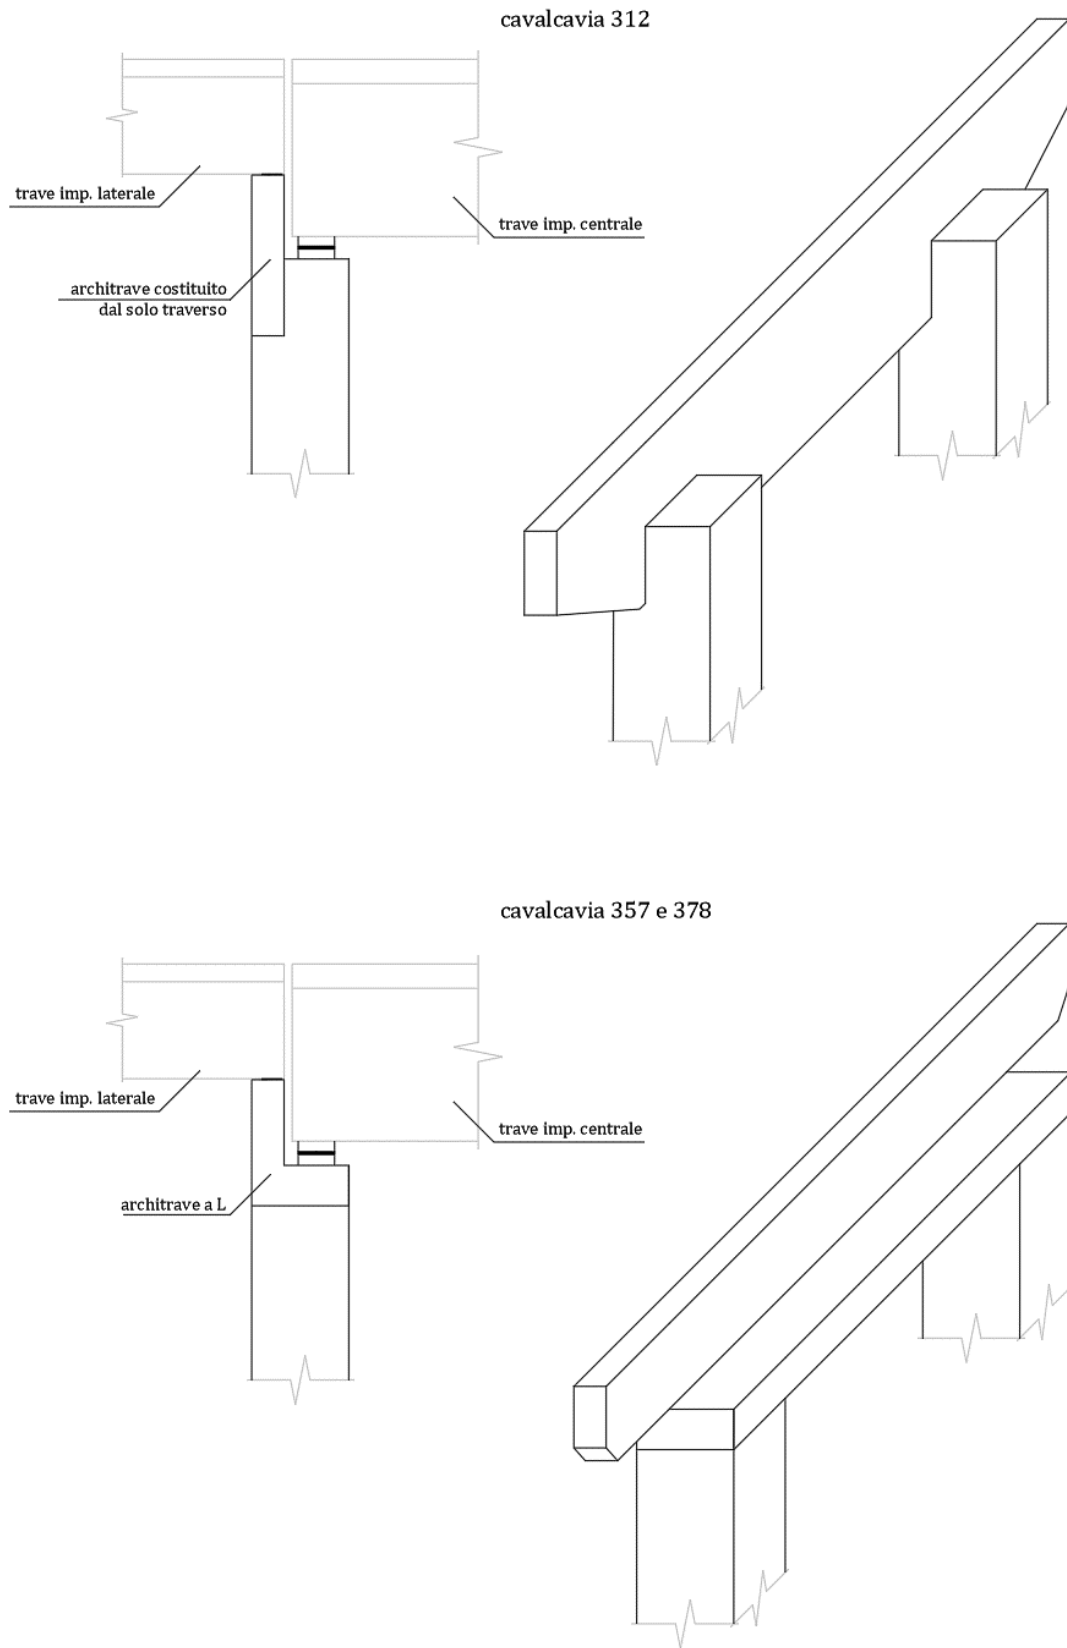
Sezione e vista assometrica dell'architrave delle pile
